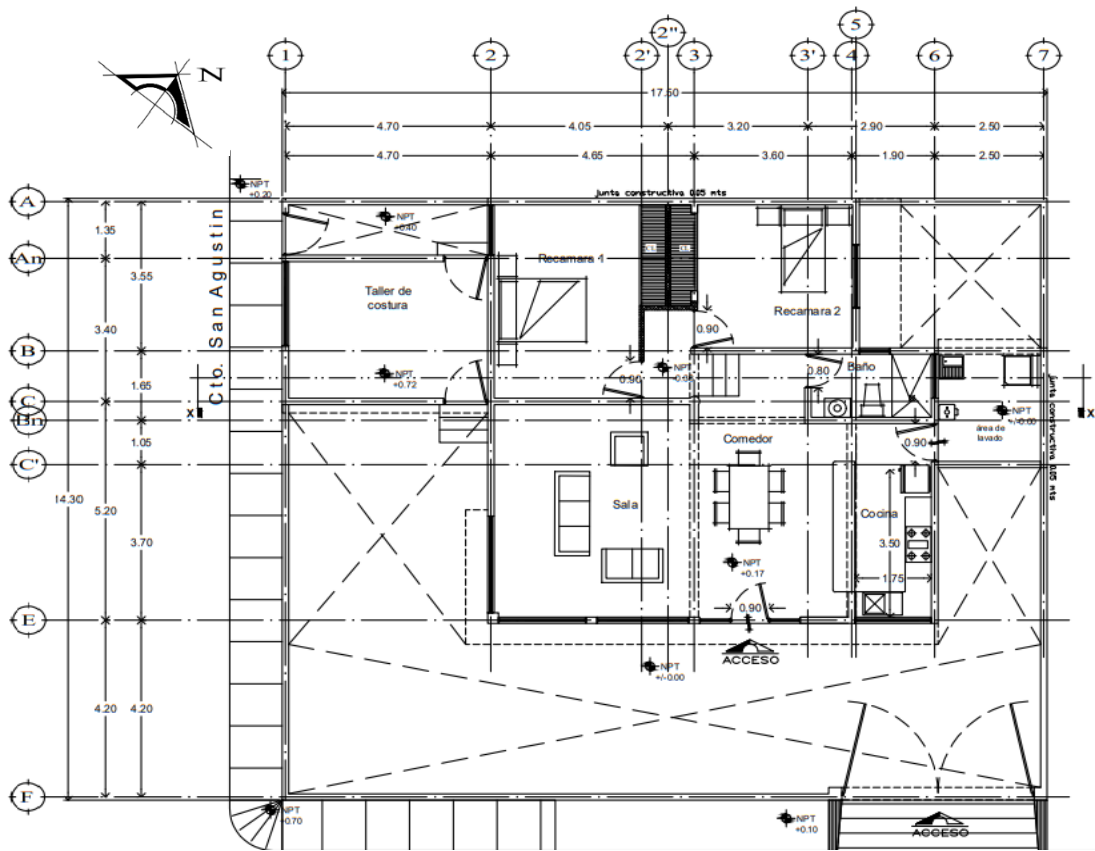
Propuesta de diseño arquitectónico, caso Leticia Navarro Alfaro.
